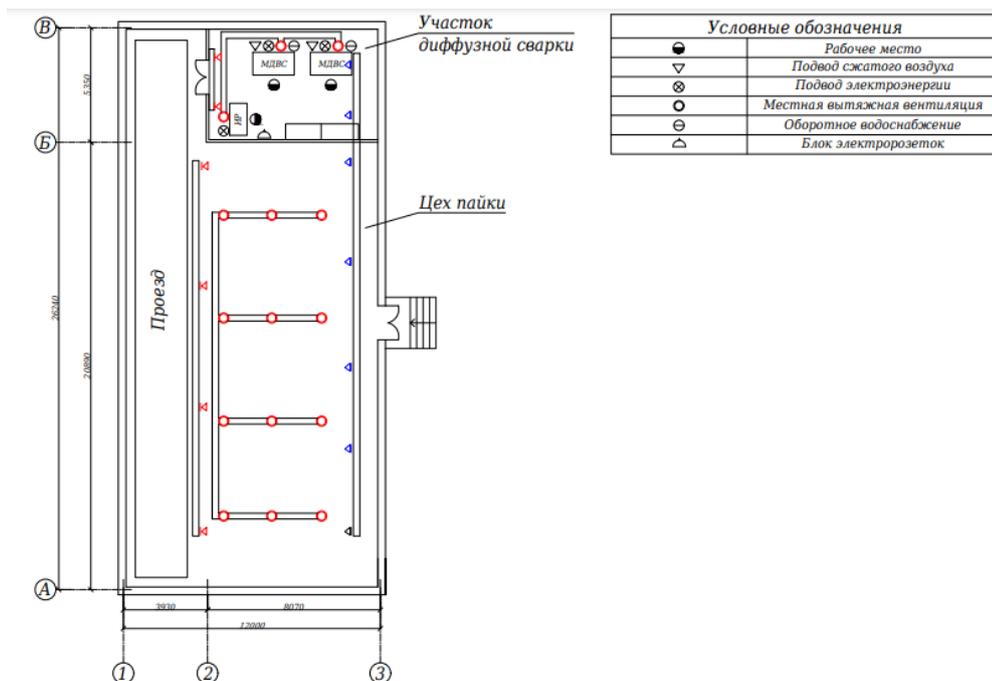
План систем вентиляции цехов пайки и сварки завода Legrand [3]
